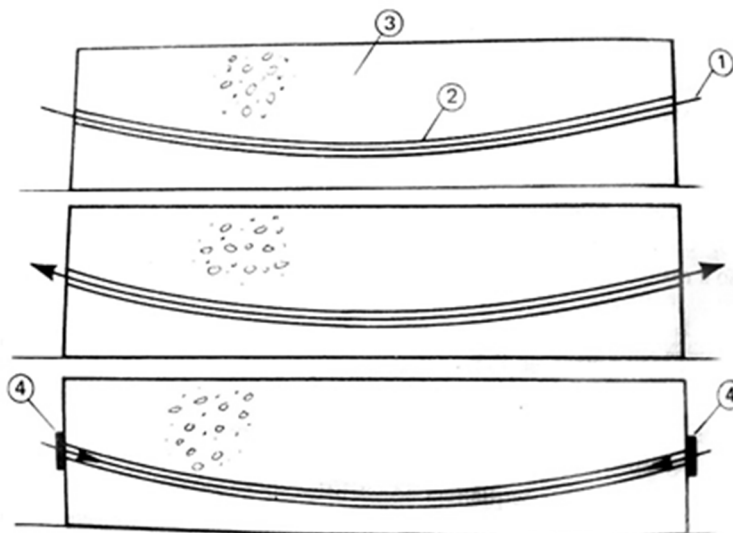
Esquema de produção de uma viga de concreto pré-tracionado.
